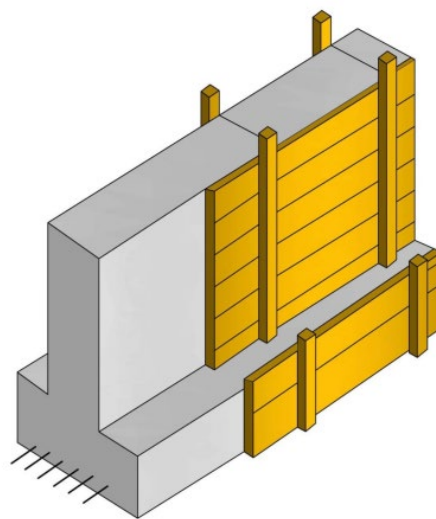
Схема влаштування опалубки монолітного стрічкового фундаменту
